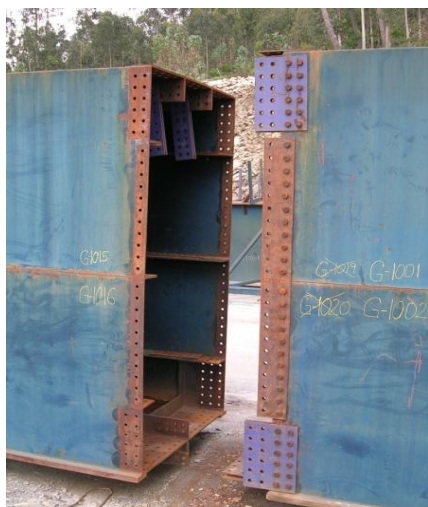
Ligações aparafusadas entre parcelas das vigas caixaão, (Viaduto 2).
